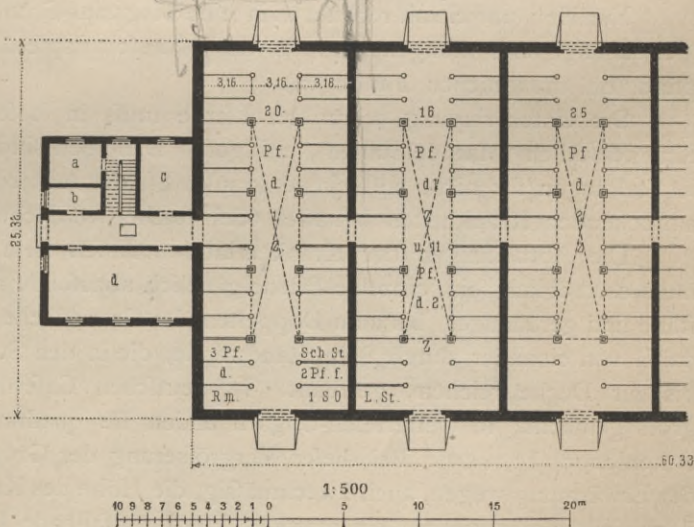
stellt den halben Grundriß eines österreichischen Escadron-Stallgebäudes mit Querreihenstellung⁴⁹⁶⁾ dar. Die Erleuchtung wird hauptsächlich durch große Deckenlichter in den Dachflächen bewirkt.
